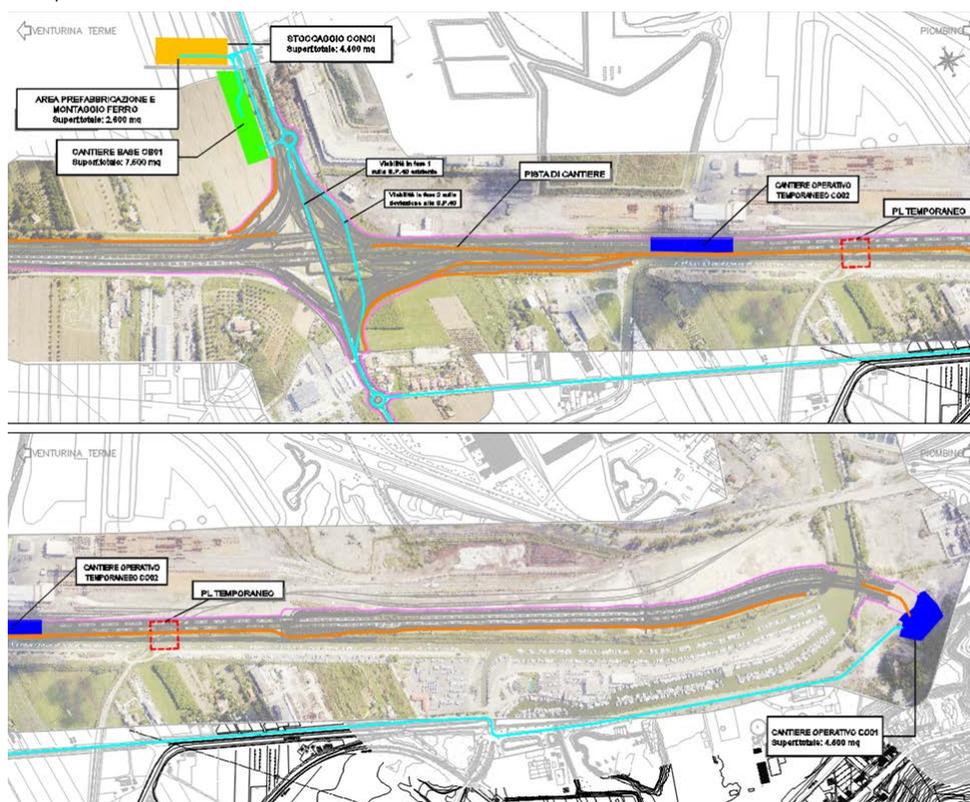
Stralcio planimetrico con localizzazione area di cantiere CO02 (Elab.: T00-CA00-CAN-PL01-A)
